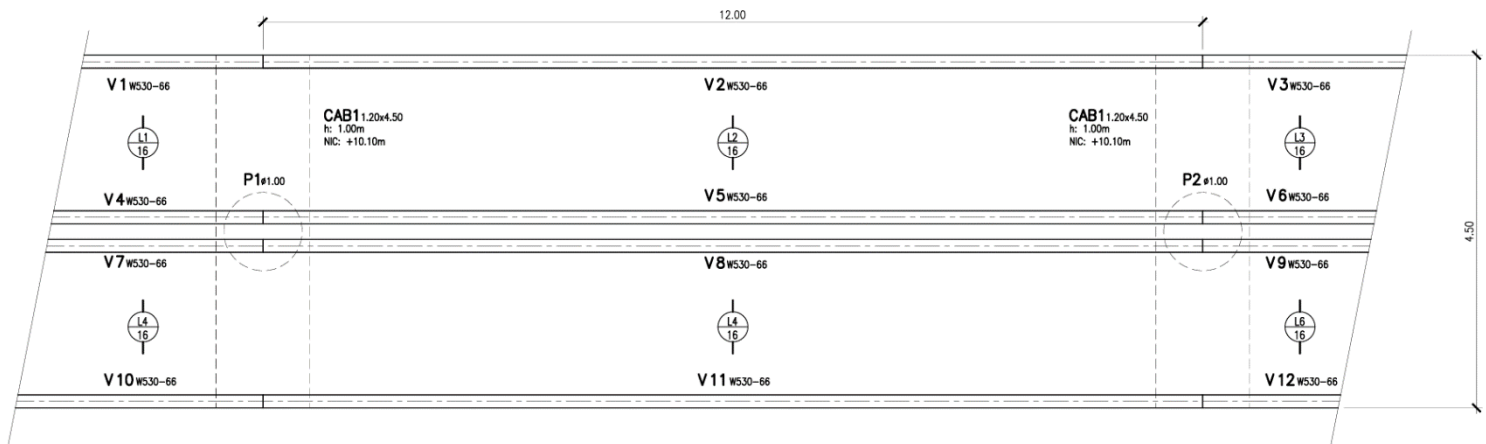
Planta del tramo típico de la pasarela
